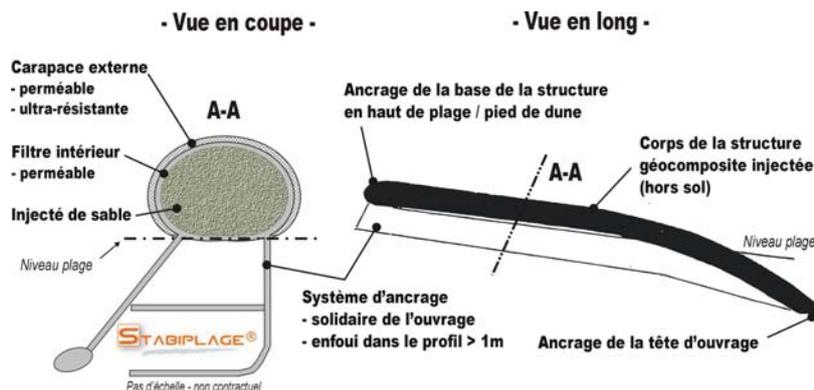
Coupe transversale et longitudinale d'un STABIPLAGE® avec ancrage
